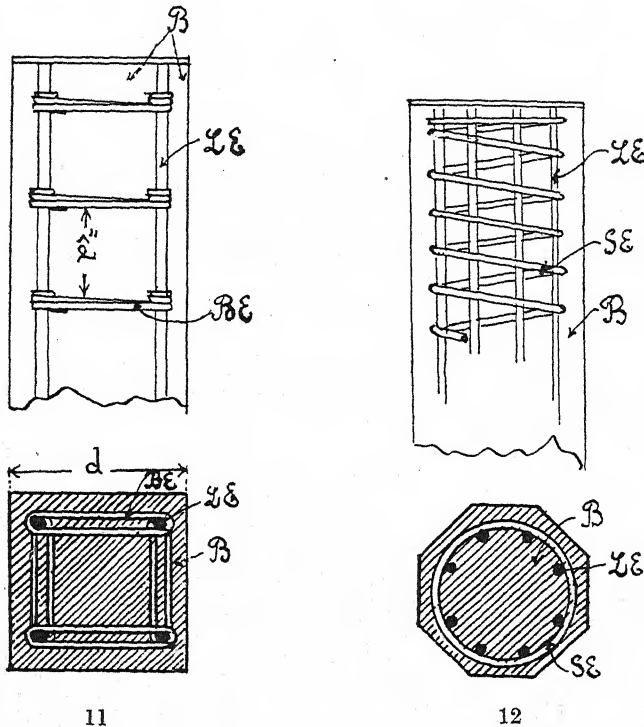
Konstruktionsschema einer mit Bügeln versehenen Eisenbetonsäule (nach FOERSTER, 55, S. 87, Abb. 33). B = Beton, BE = Bügeleisen, LE = Längseisen.
